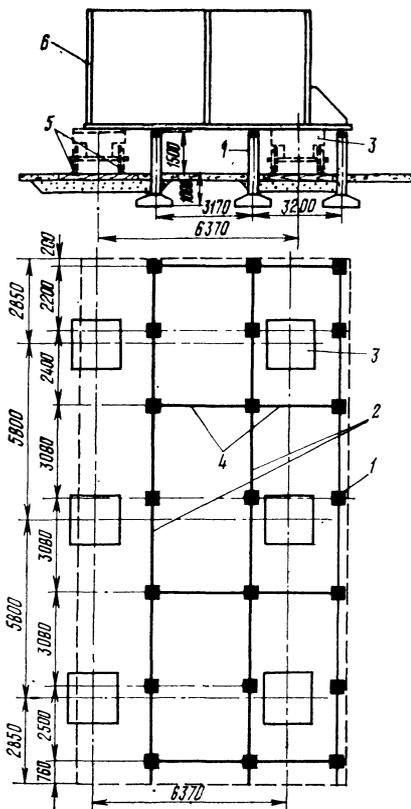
Стапельное место для монтажа массивов-гигантов:
